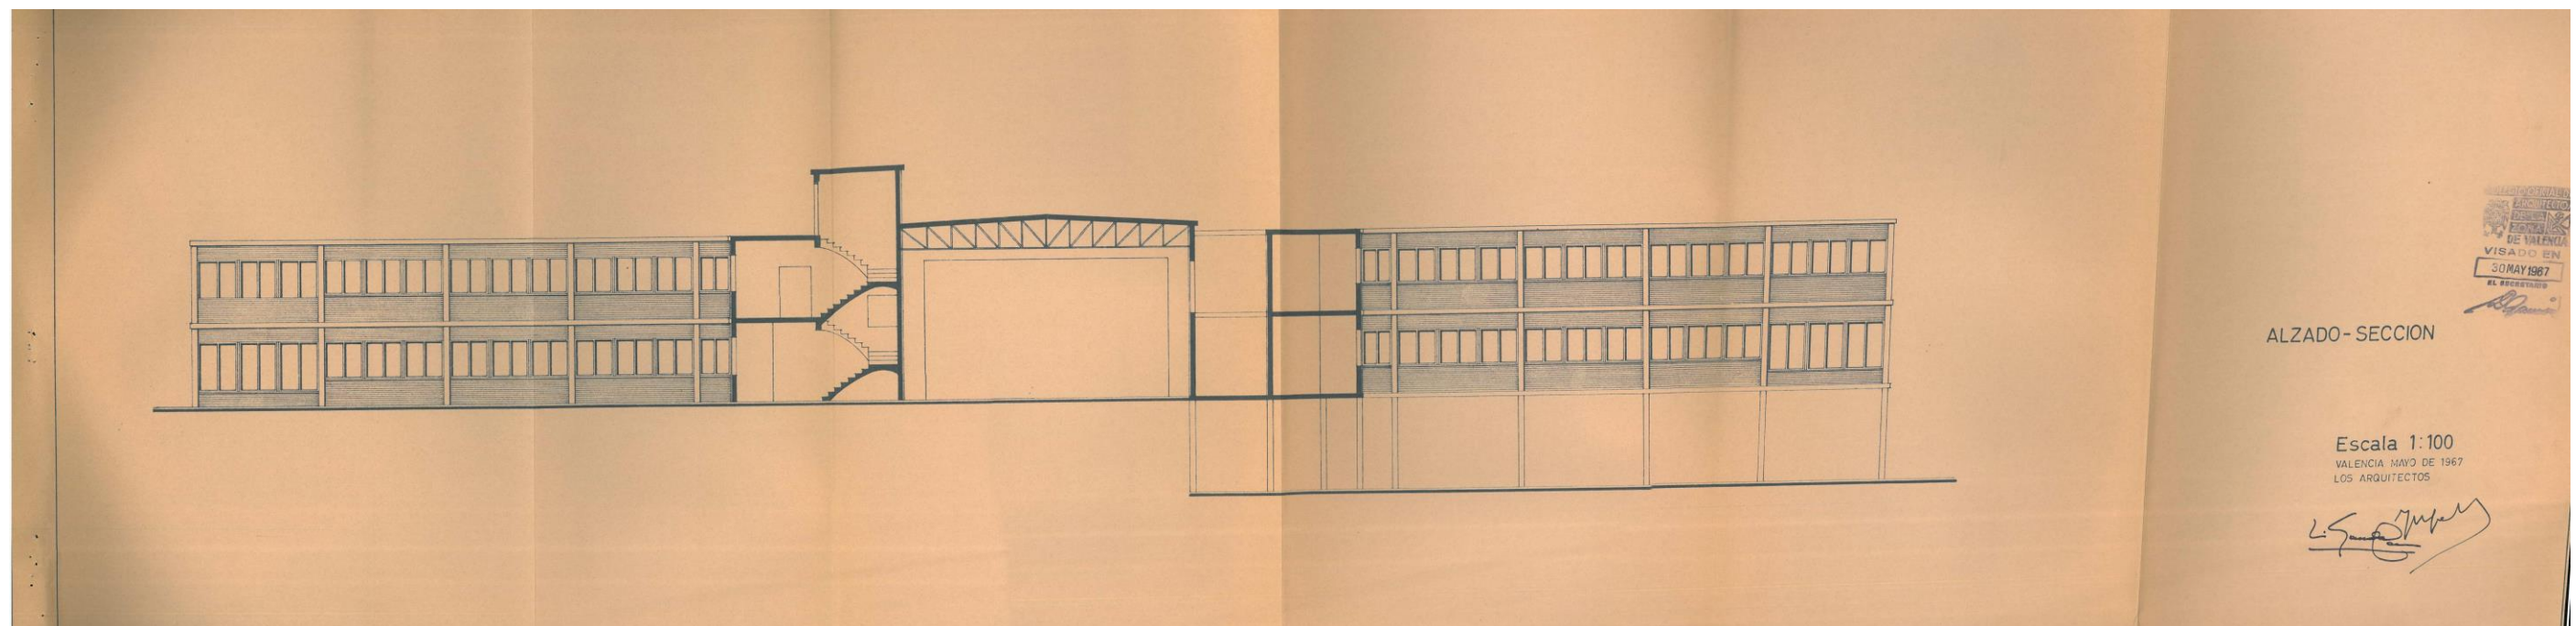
Plano Alzado y Sección. Fuente. Archivo Urbanístico de Oliva, Ayuntamiento de Oliva.
